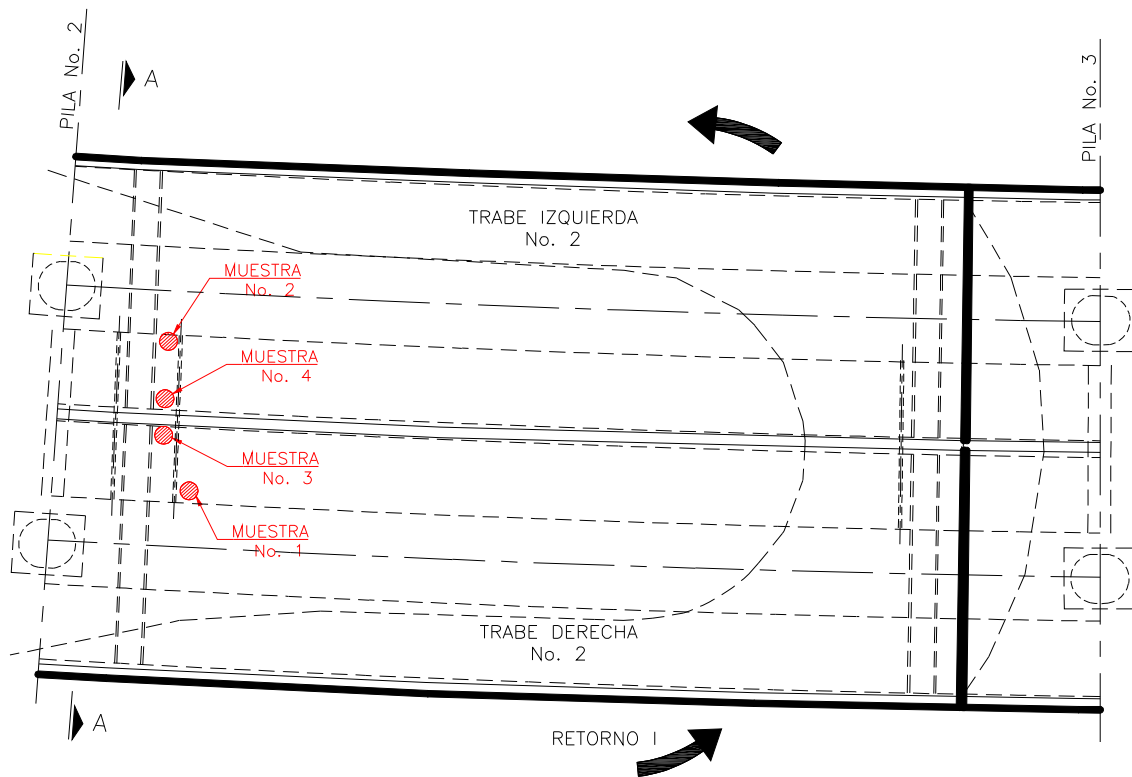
Ubicación en planta de Pruebas de extracción de corazones.
